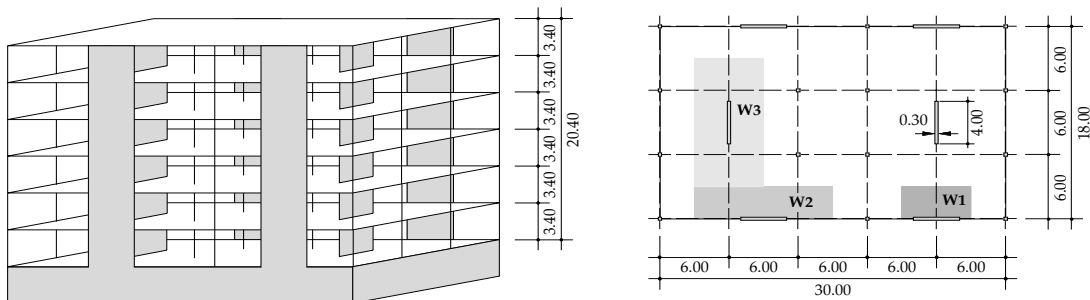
6-geschossiges Referenzgebäude: Isometrie (links), Grundriss eines Obergeschosses (rechts). [m].
